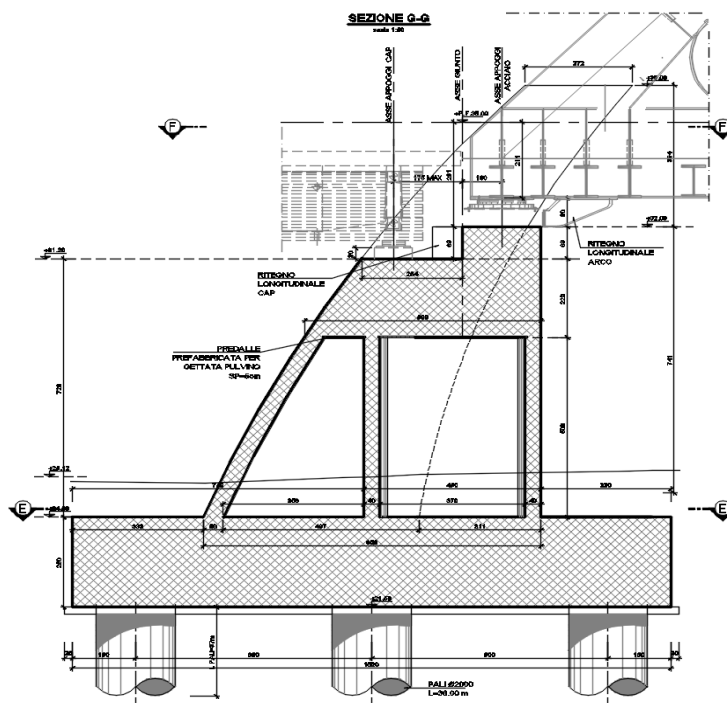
Pila P.11 VI.03 – sezione longitudinale
